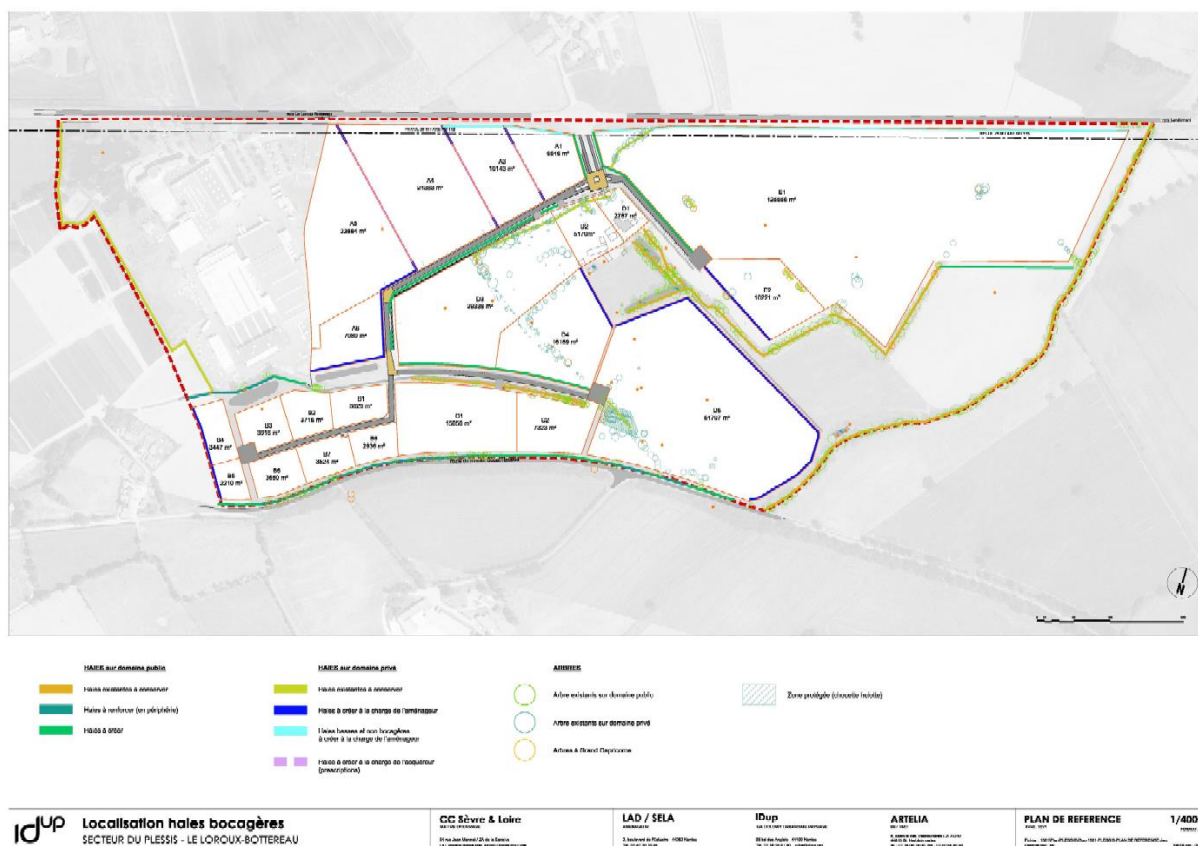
Plan d'aménagement de la ZAC depuis 2021 (source : Porter à connaissance)
